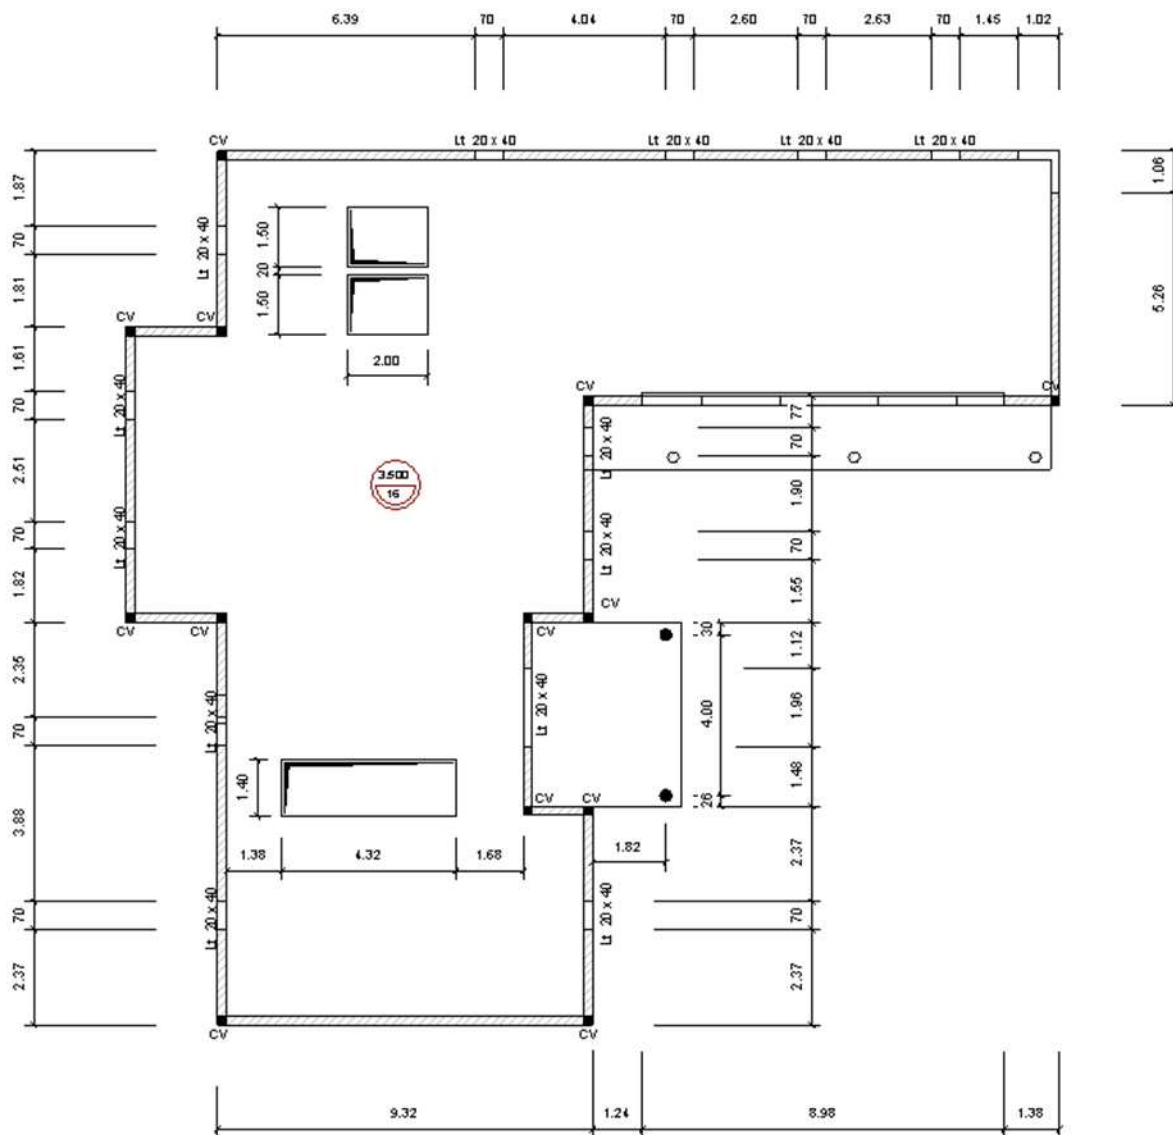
Plan de coffrage du plancher haut du rez de chaussée
